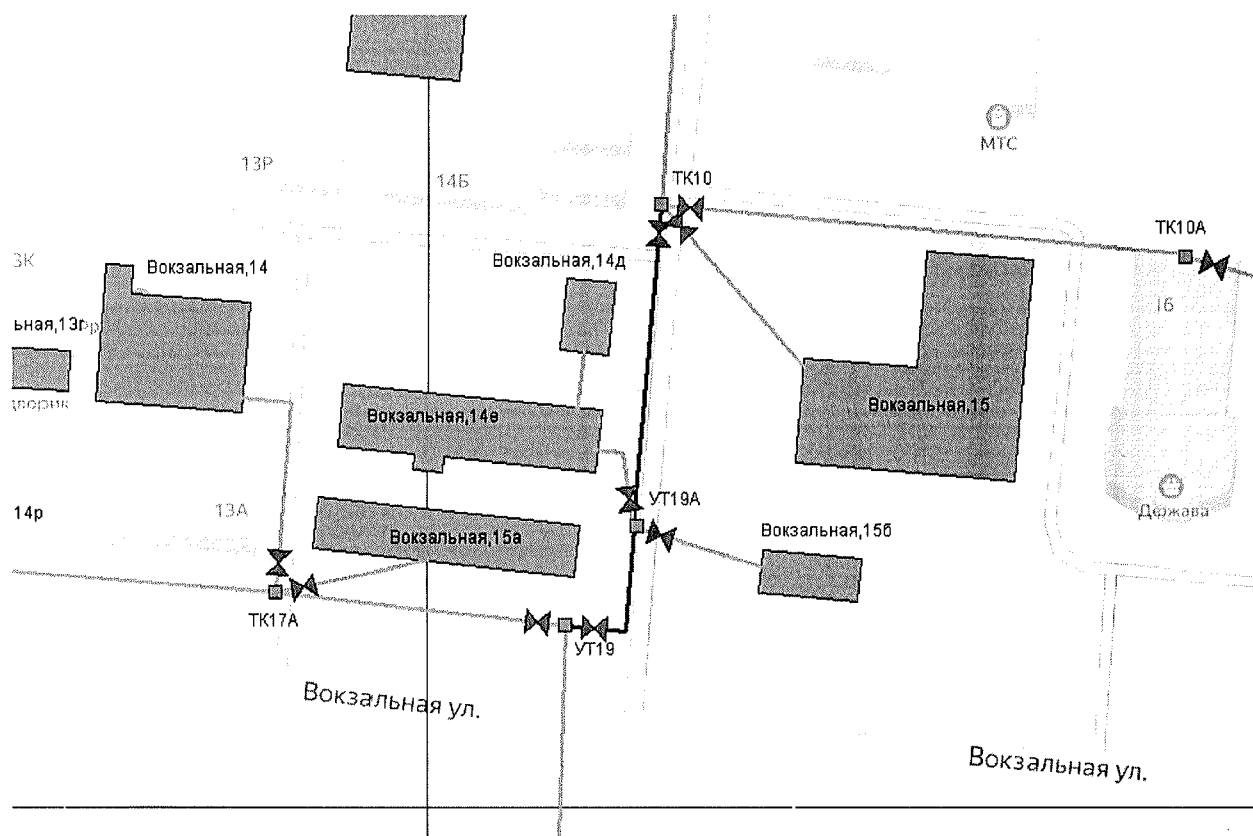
Трубопроводы, перекрытые для проведения ремонтных работ.
